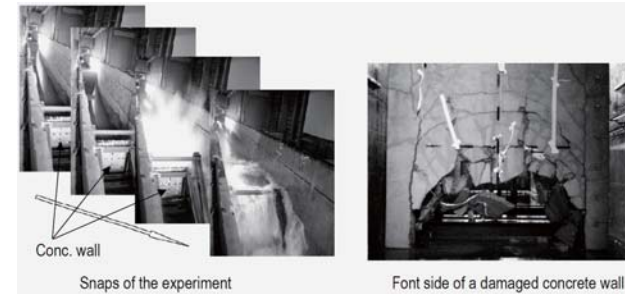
コンクリート版の破壊実験 (厚さ 100mm)
